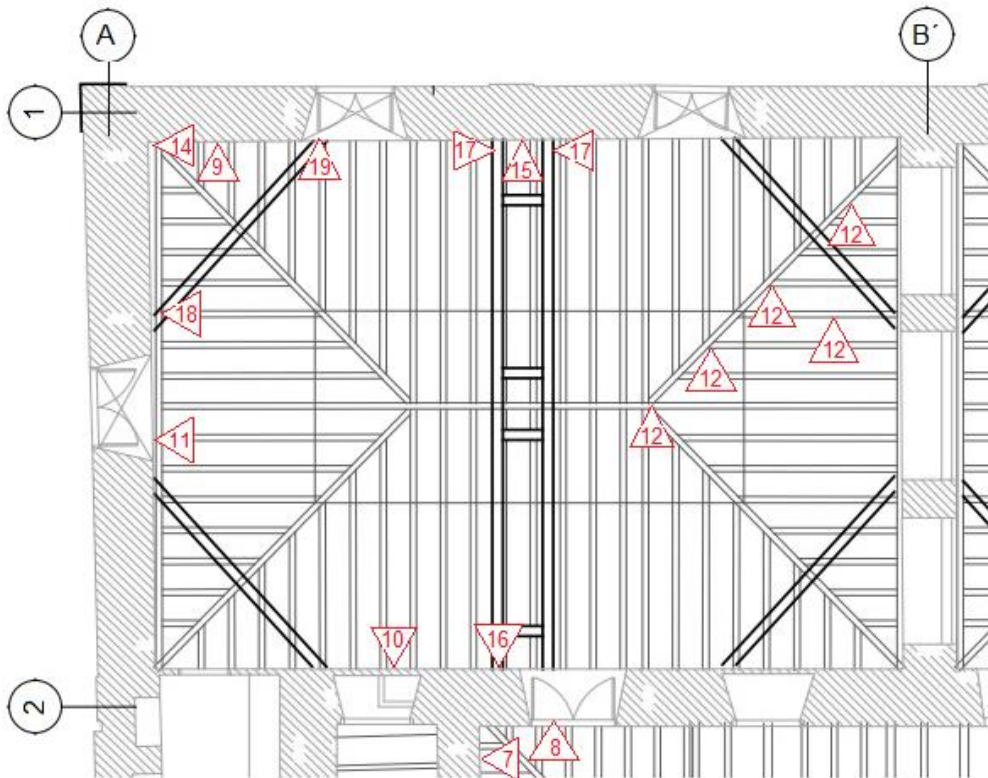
Planta arquitetônica do Coro Alto, onde estão localizadas as lesões associadas às Figuras 7-12 e 14-19.
